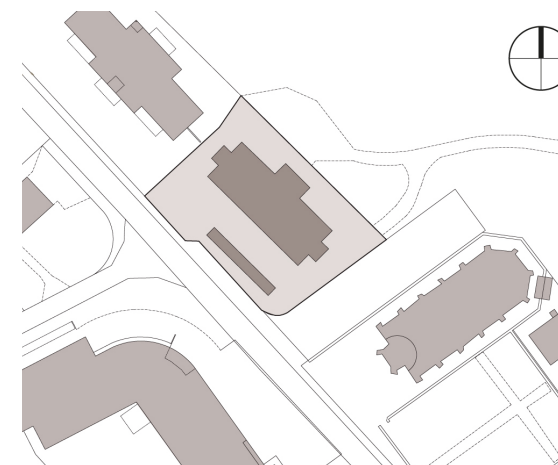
Planimetria generale; Fonte: www.720grad-architekten.ch
